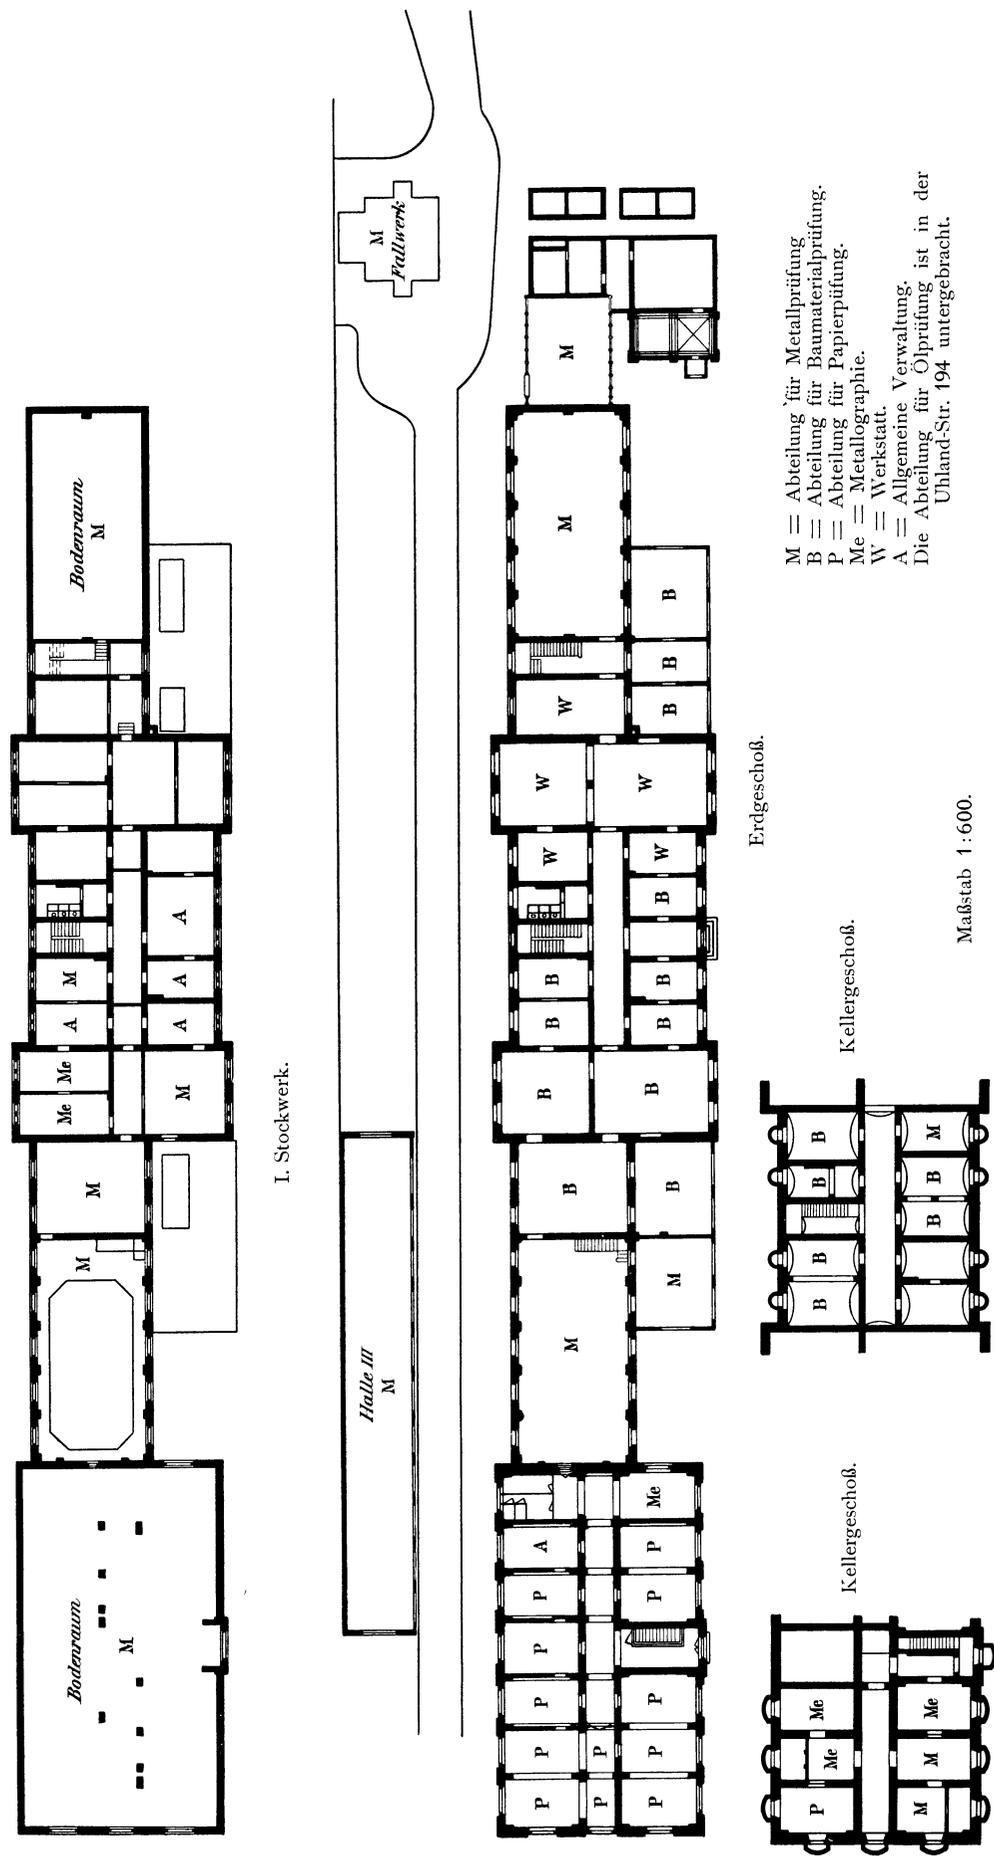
Mechanisch-Technische Versuchsanstalt am 1. April 1903.
